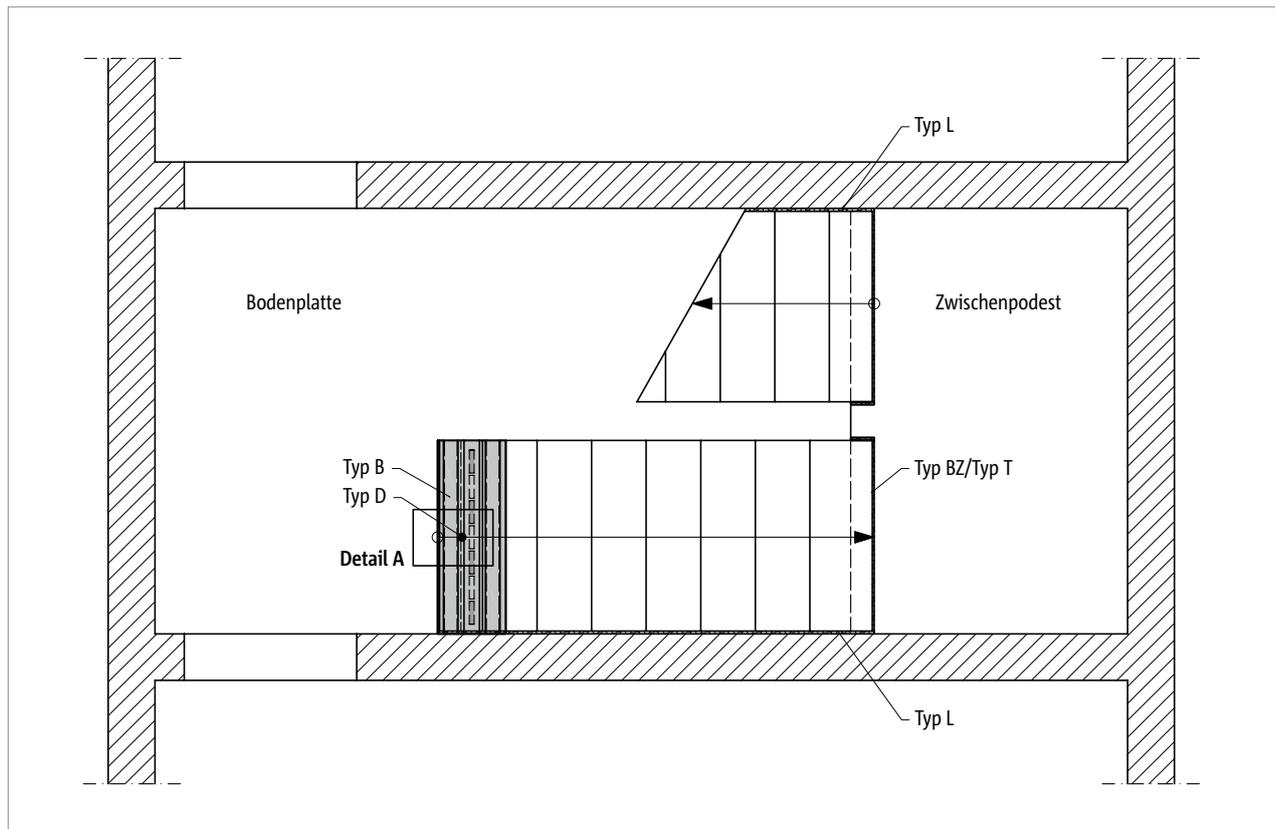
Schöck Tronsole® Typ B + Typ D: Elementanordnung im Grundriss
